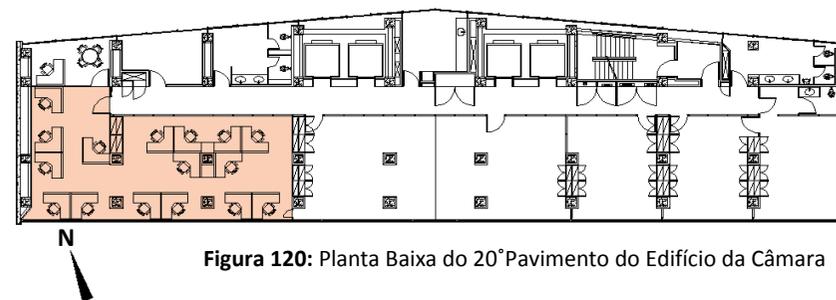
Planta Baixa do 20º Pavimento do Edifício da Câmara
